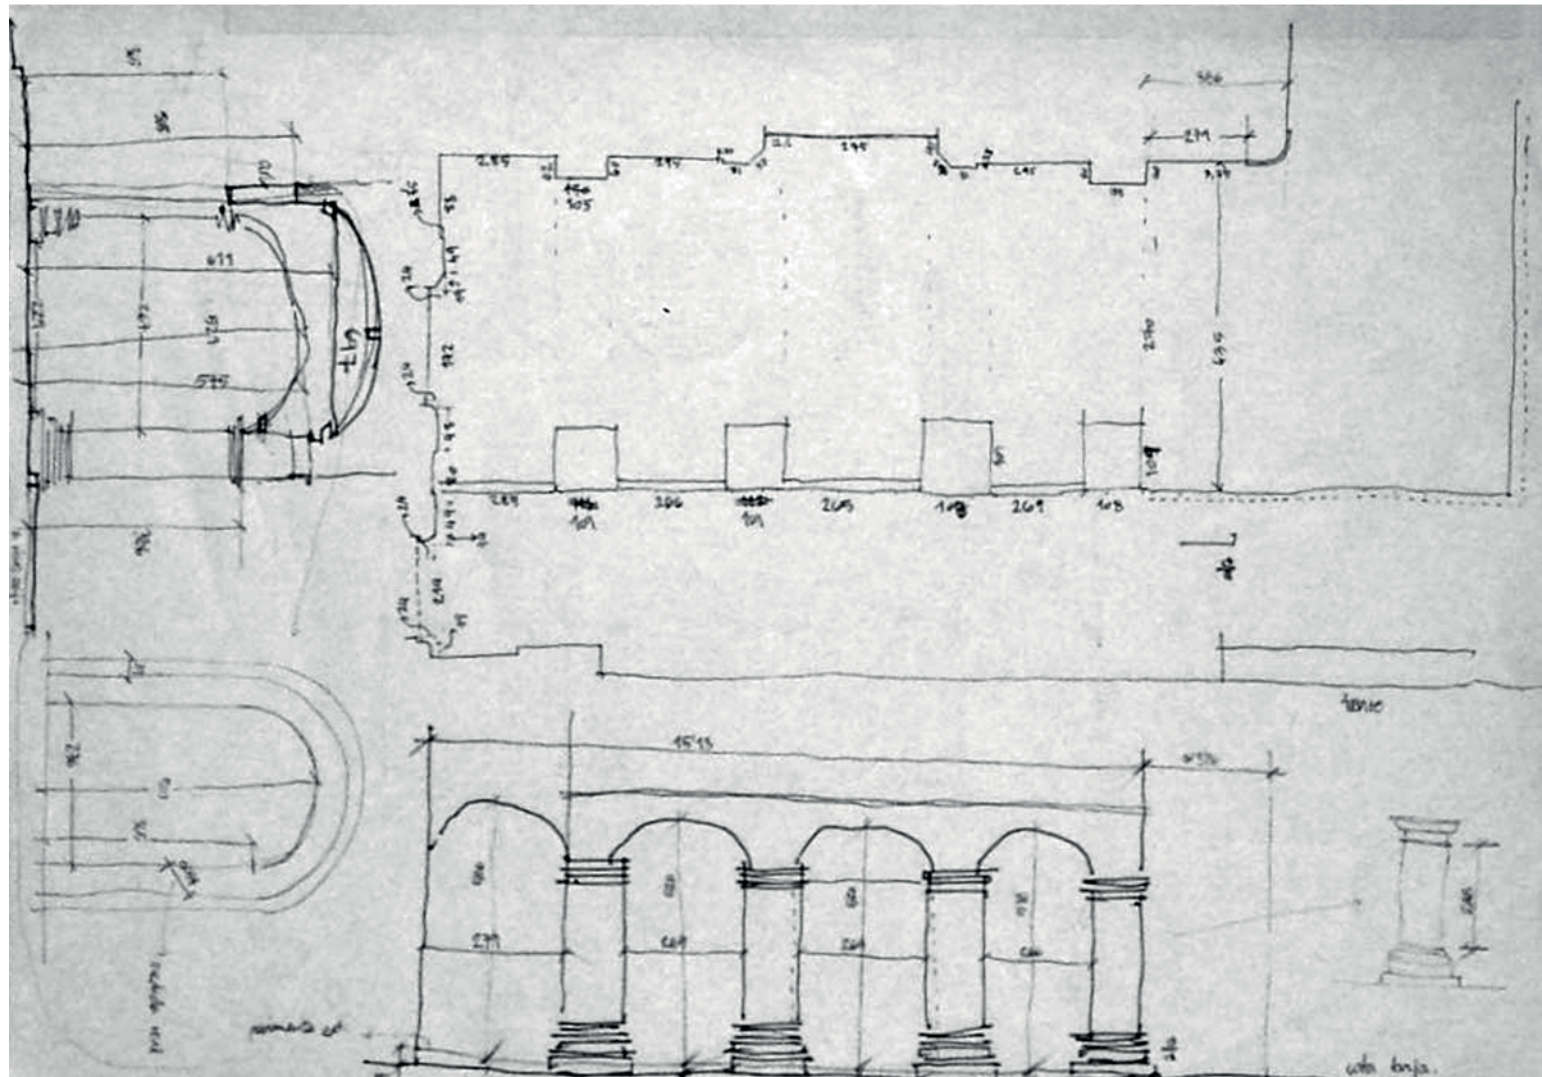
Croquis de la planta y alzado del atrio de la Iglesia de San Gonalo de Amarante y alzado de acceso
